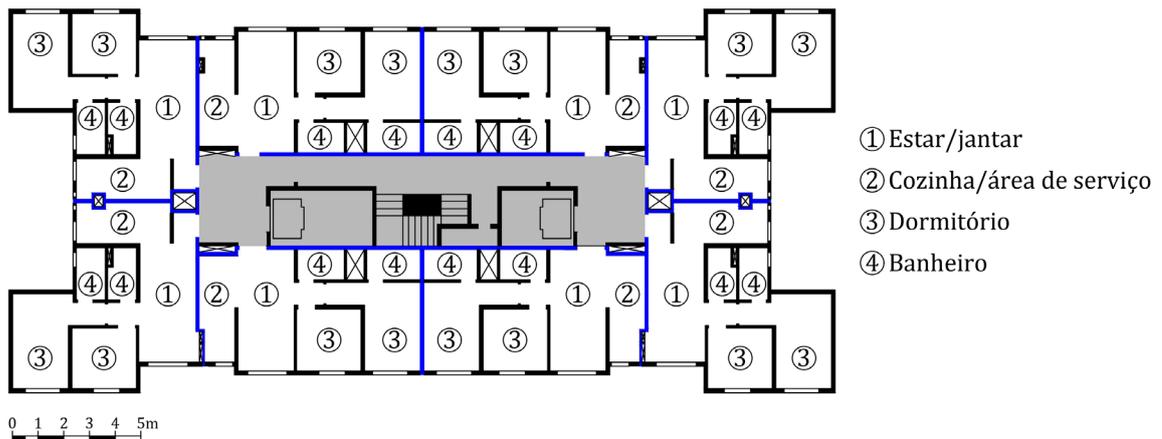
Planta do Objeto de estudo 10. Esquema sem escala.
